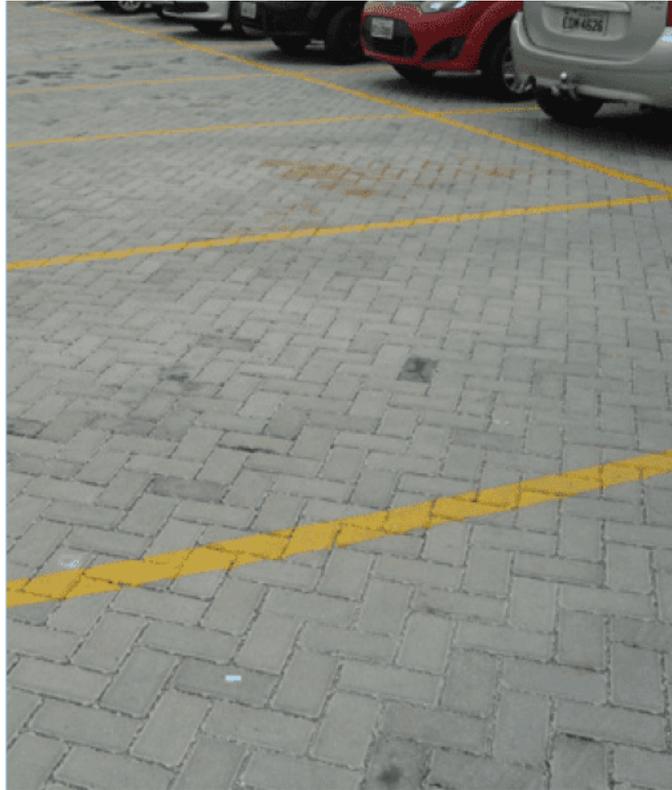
Pavimento de blocos de concreto poroso e permeável em estacionamento
